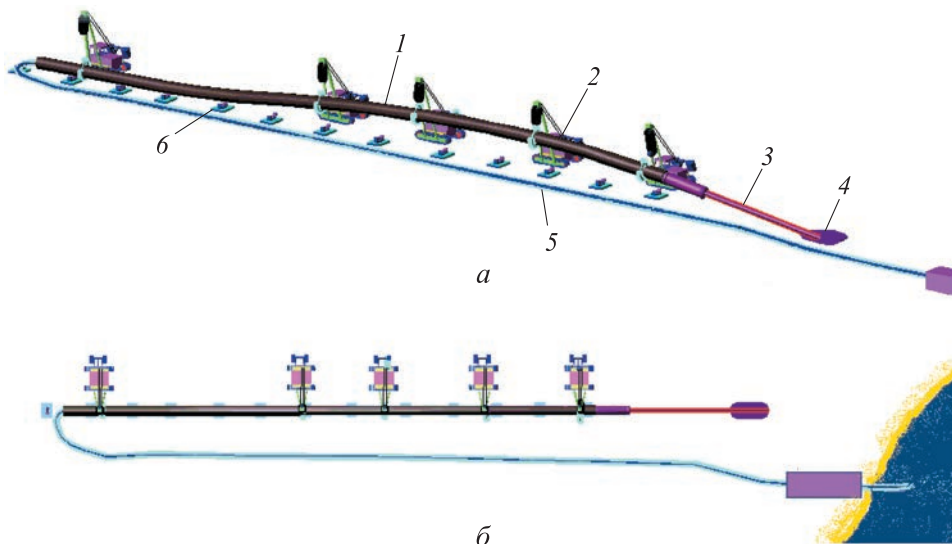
Общий вид (а) и вид сверху (б) трубопровода на монтажной площадке перед протаскиванием:
